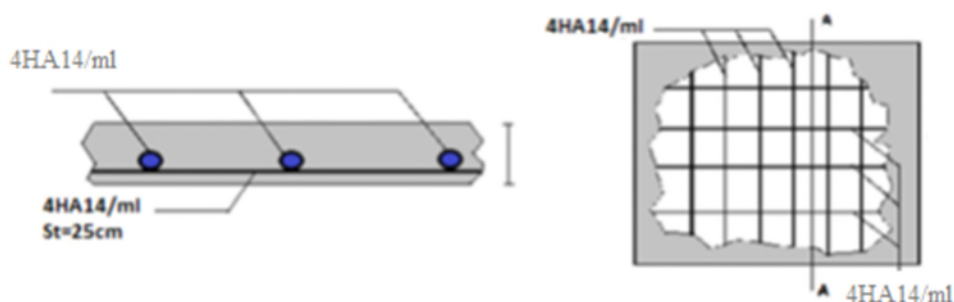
Schéma de ferrailage dalle ascenseur (charge concentrée)
